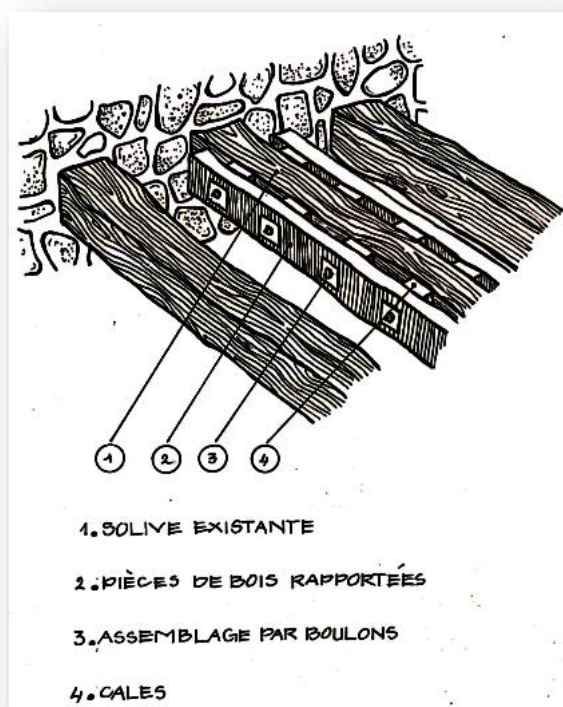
Renforcement d'une solive sur toute sa longueur.
